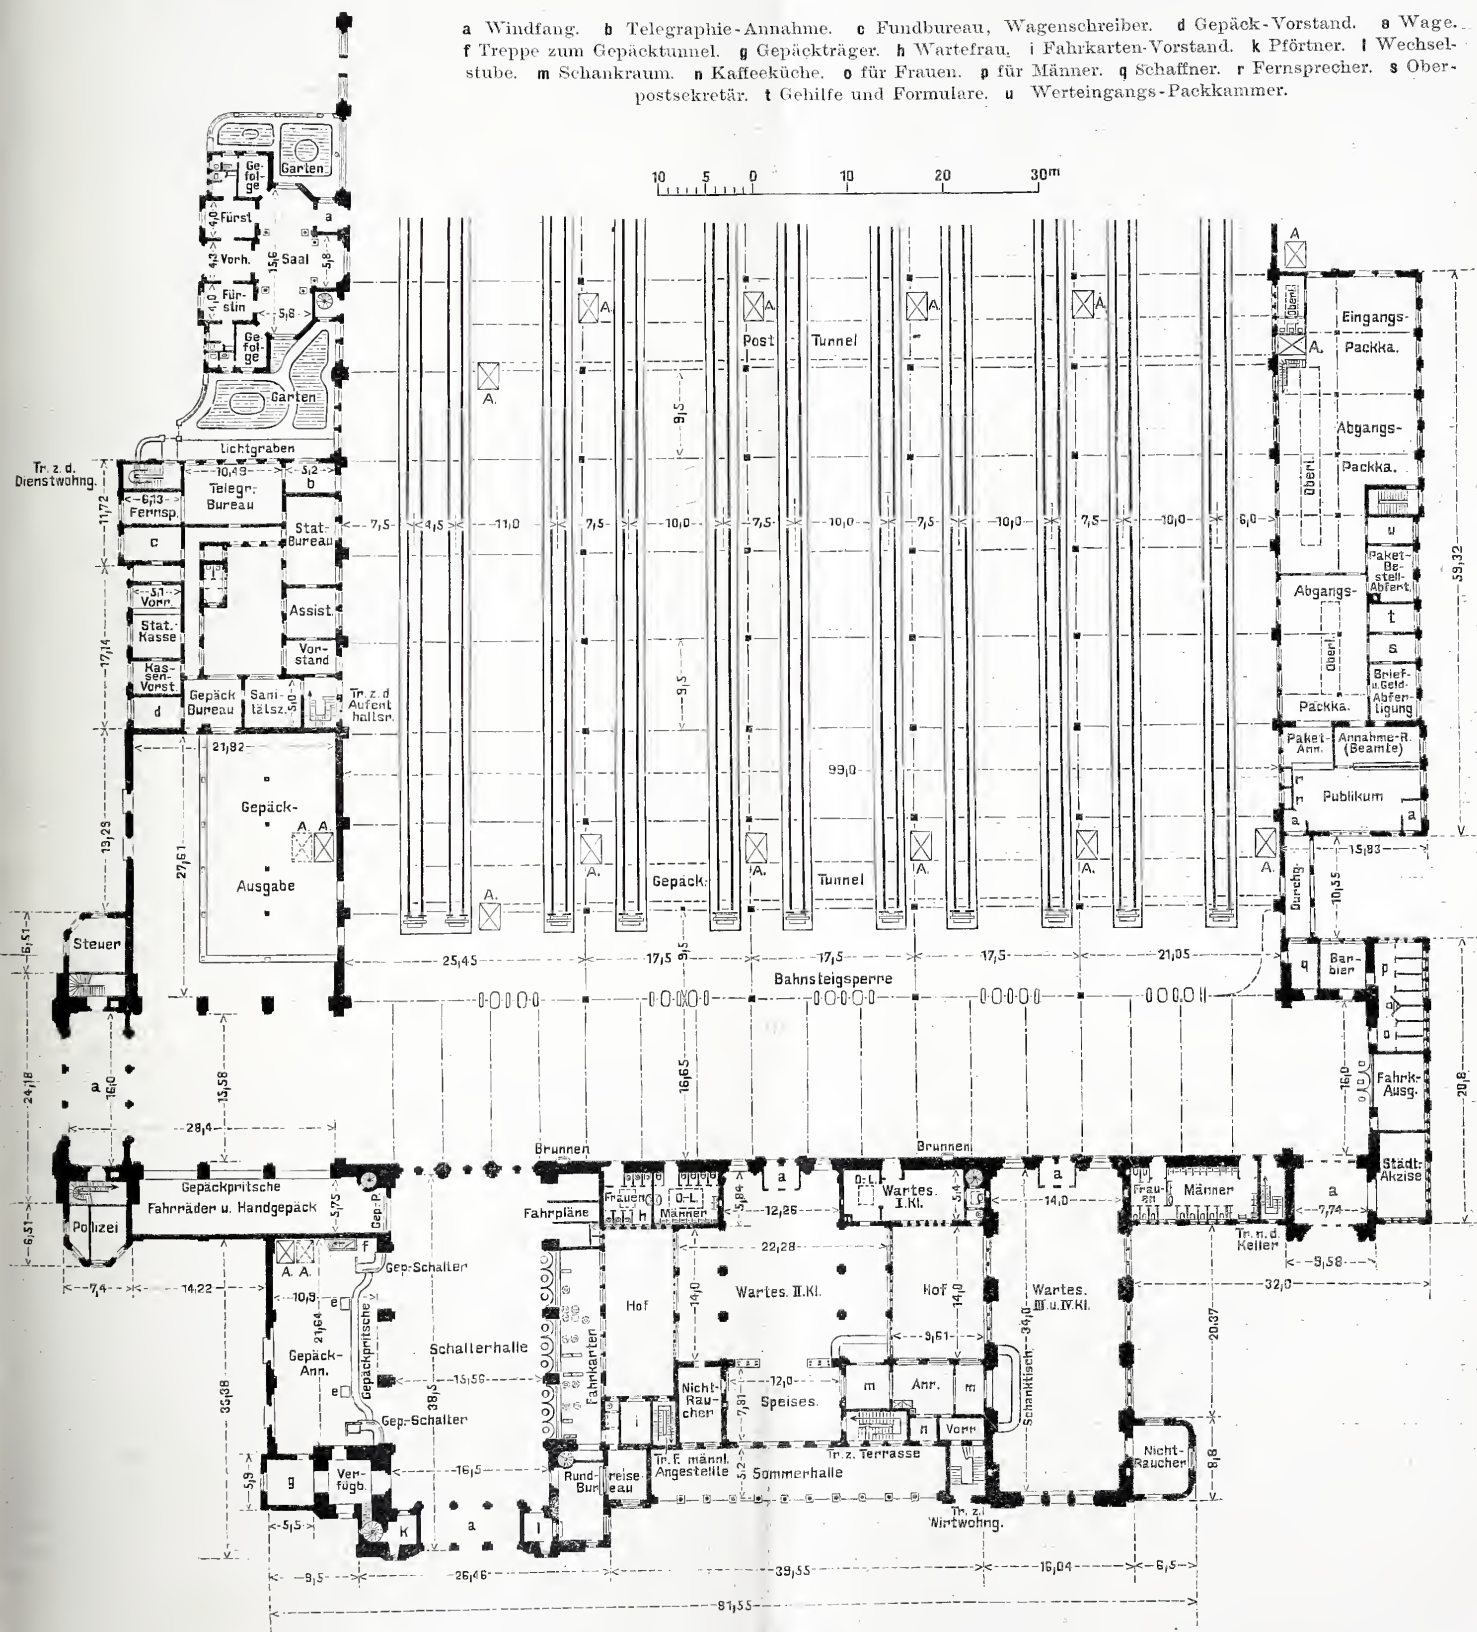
Erdgeschoß-Grundriß vom neuen Bahnhofsgebäude in Wiesbaden.
